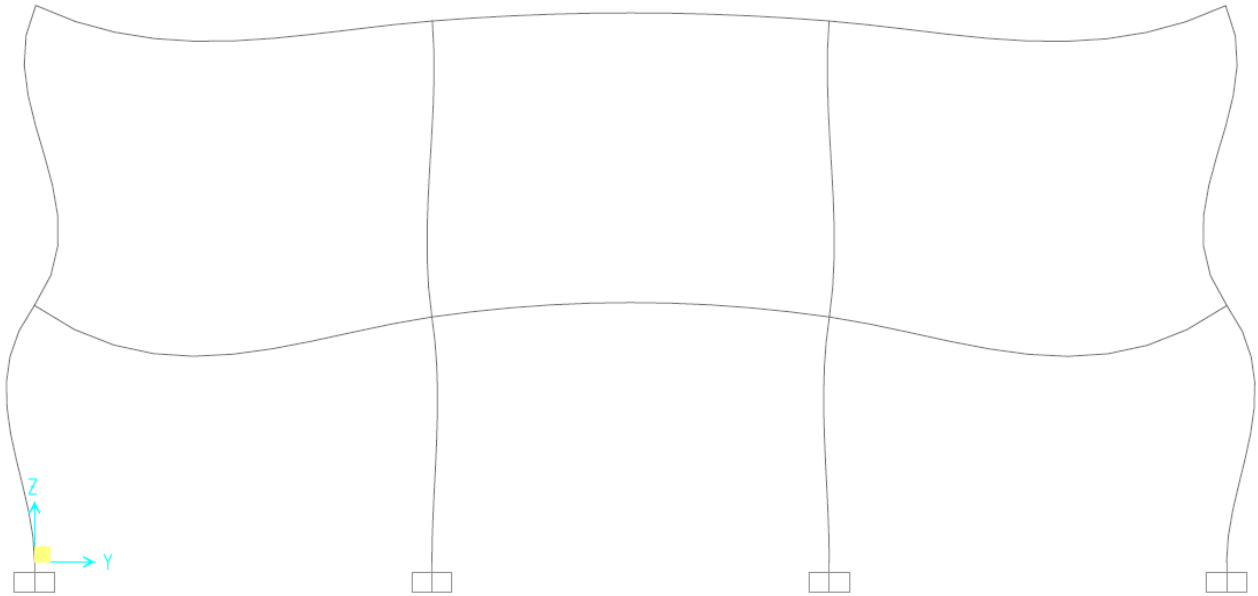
PÓRTICO 1 – DEFORMADA ELStab
